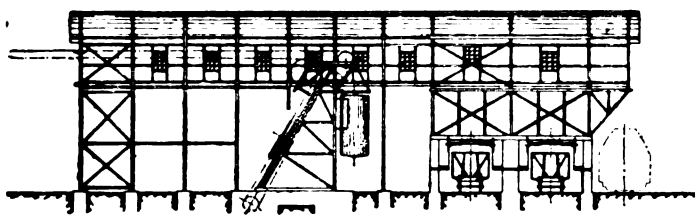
Ferrovia aerea su cavi - Sezione trasversale della stazione di scarico.
